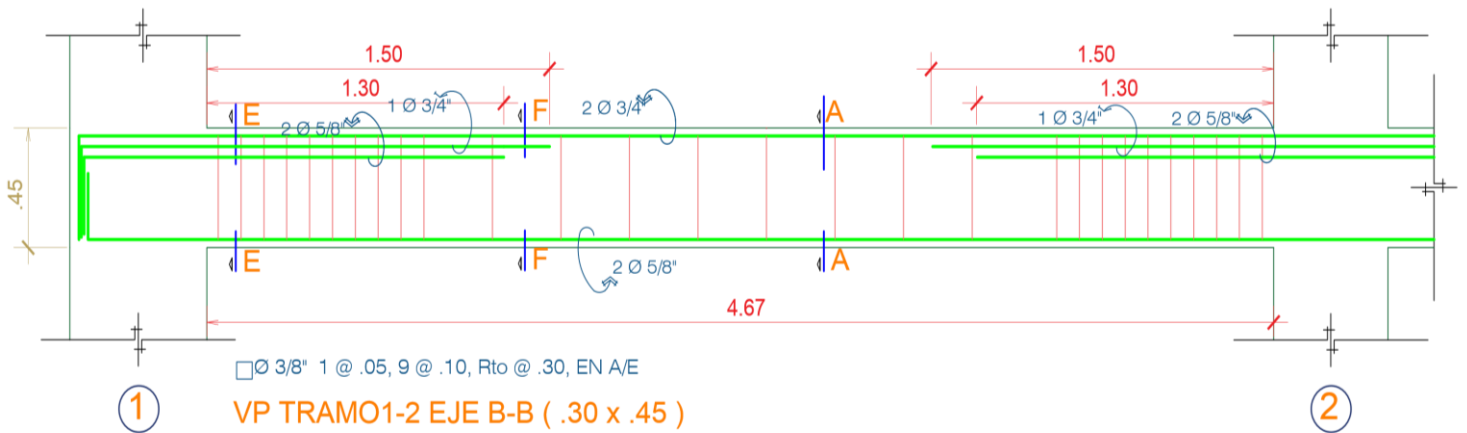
Detalle de viga tramo 1-2 ,Eje B-B.
